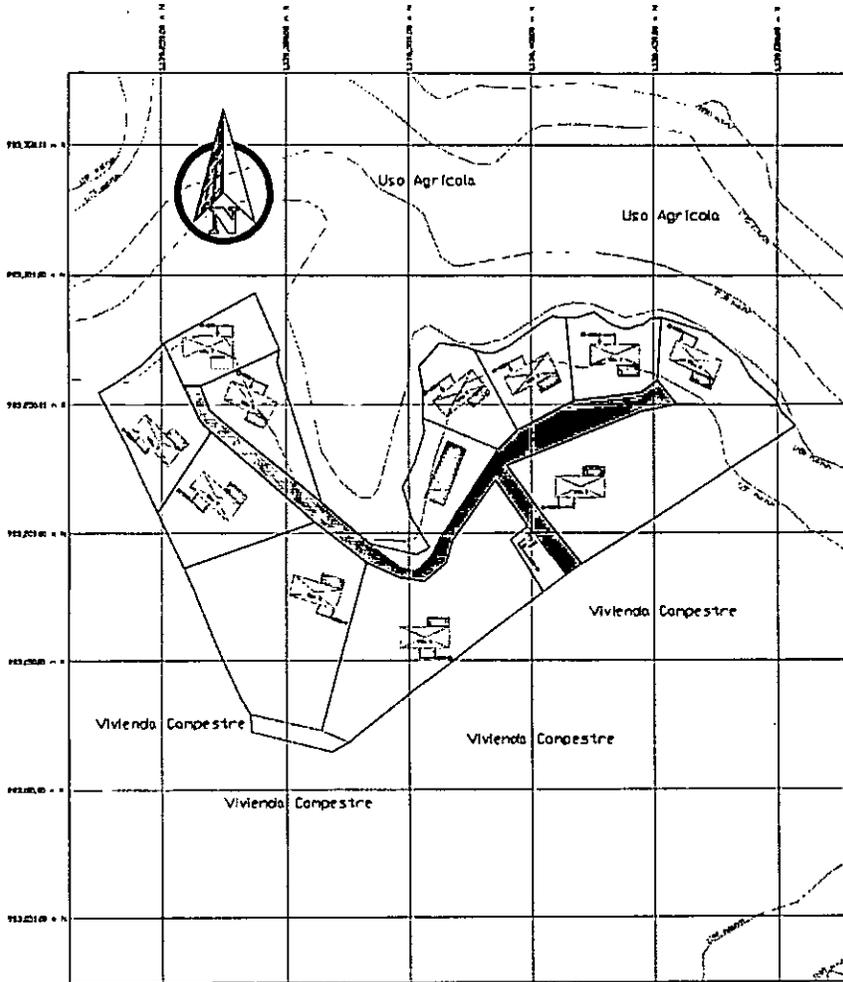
Implantación del proyecto CABO VERDE COUNTRY
